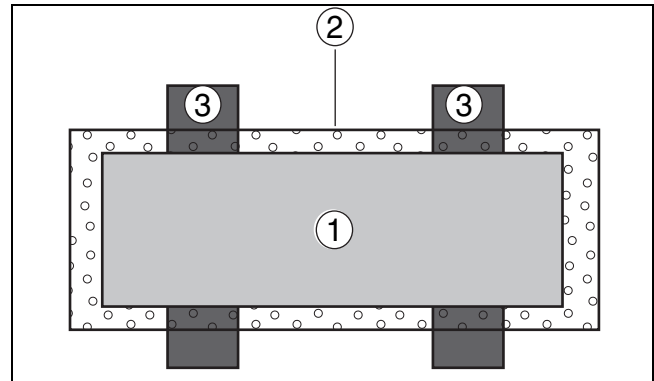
Unità esterna su staffa a pavimento (vista dall'alto)
